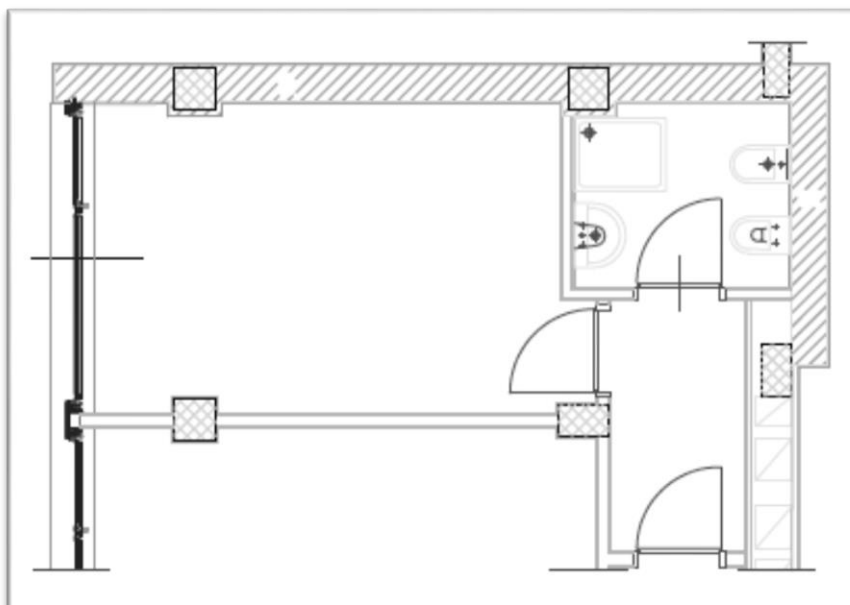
Pianta tipologia Iridium - Fonte: archivio In-Domus
